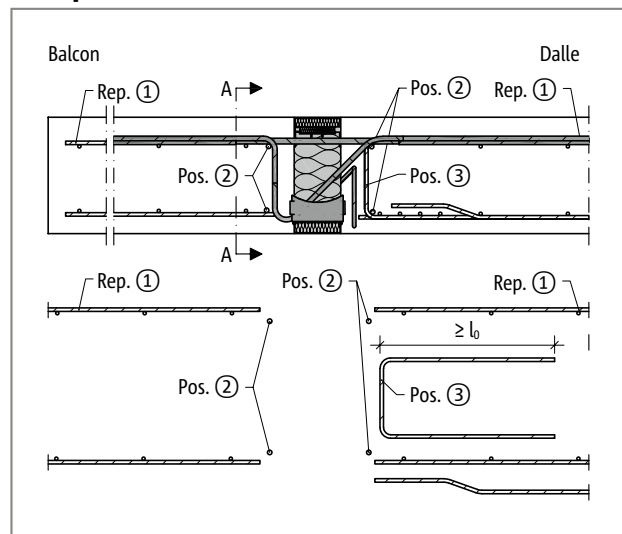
Schöck Isokorb® T Type K-E, K-T : Renforcement sur site ; plancher avec poutres de rive
